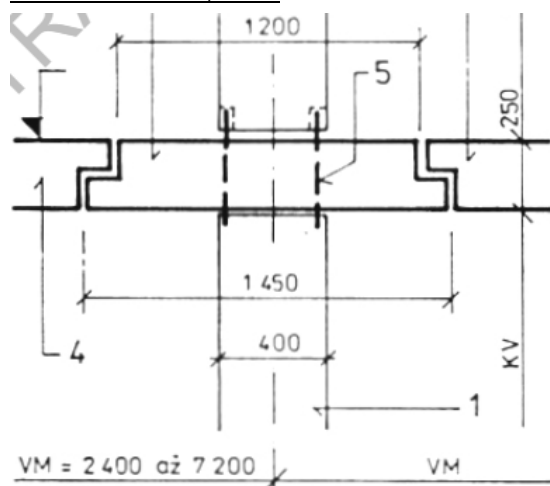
prefa ŽB sloupový skelet MS 71 – styk sloupu s deskovým průvlakem a uložení stropního panelu
